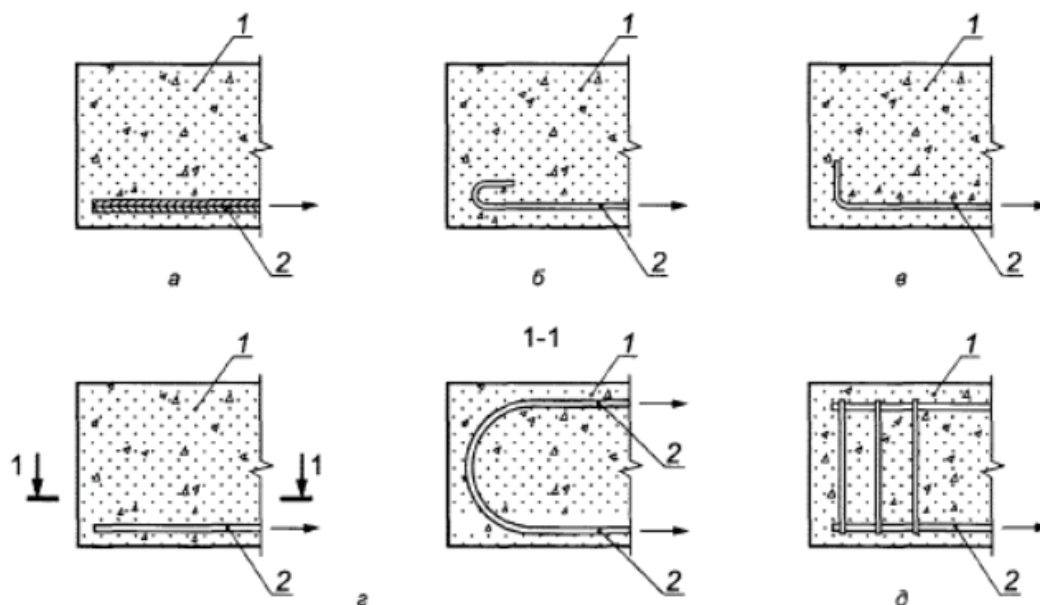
Типы анкеровки арматуры: а — сцепление прямых стержней с бетоном; б — крюками; в — лапками; г — петлями; д — приваркой поперечных стержней; 1 — бетон; 2 — анкеруемый стержень
